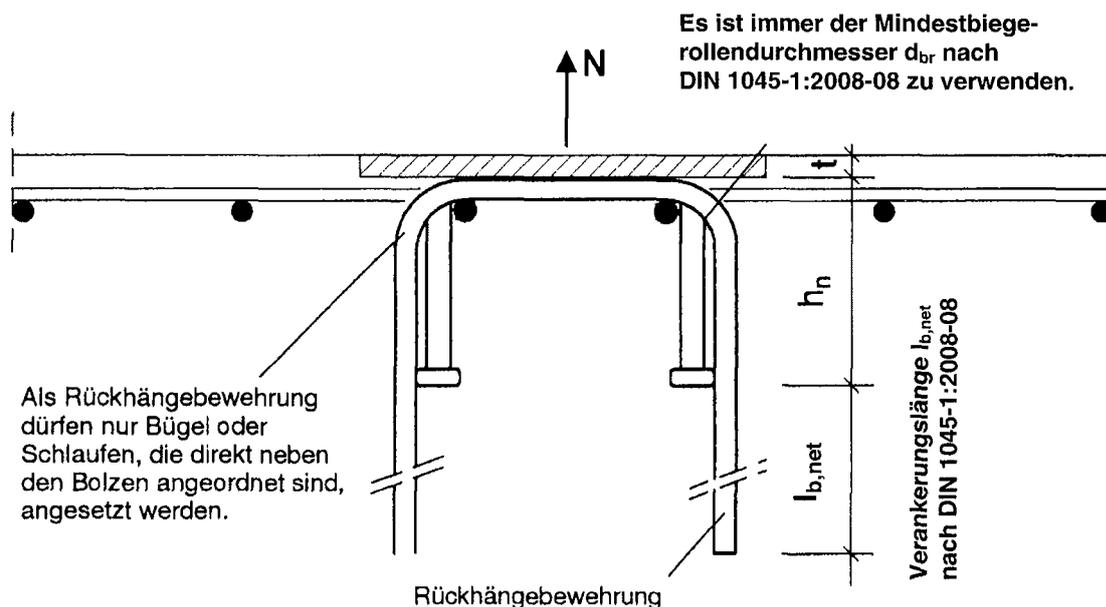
Konstruktive Ausbildung der Rückhängebewehrung
